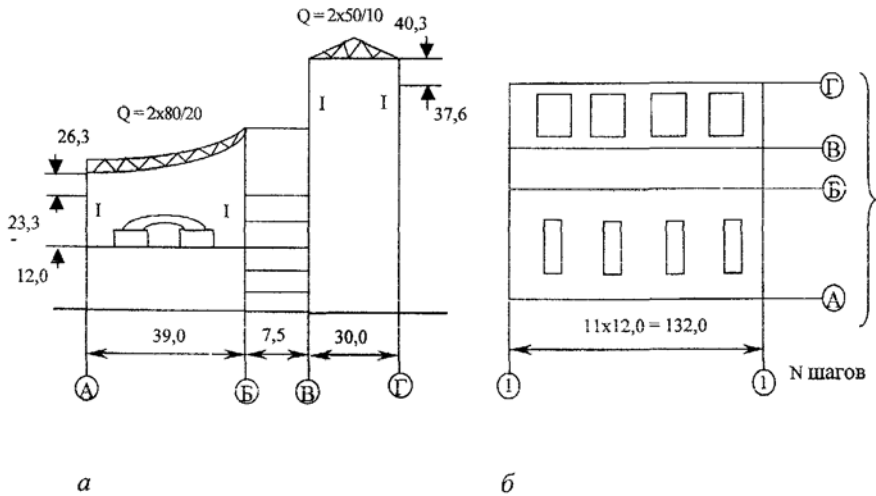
Главный корпус Таллинской ТЭЦ-2: а – разрез ГК; б – план ГК
